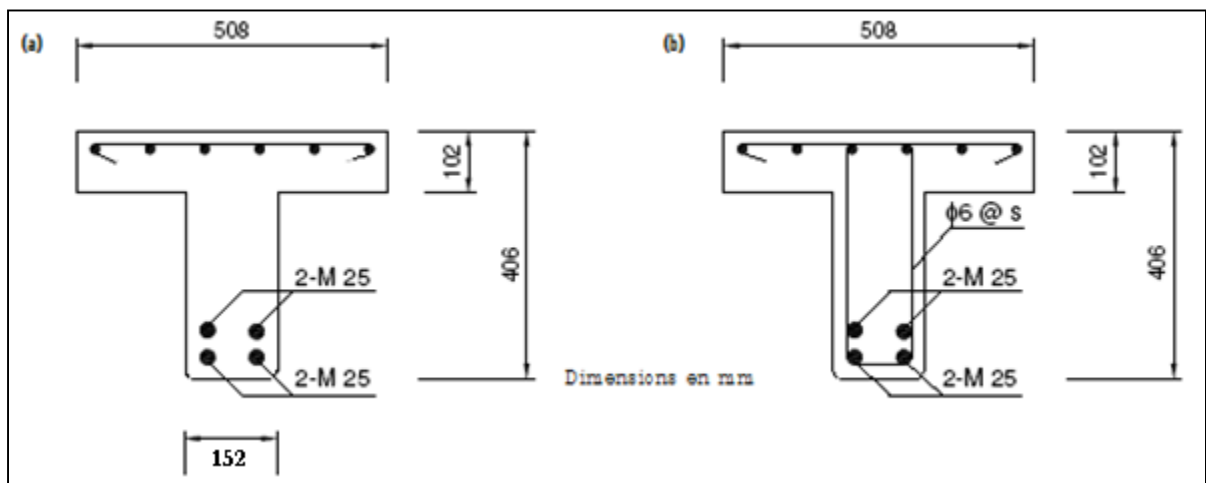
Section des spécimens testés : (a) sans étriers ; (b) avec étriers.
